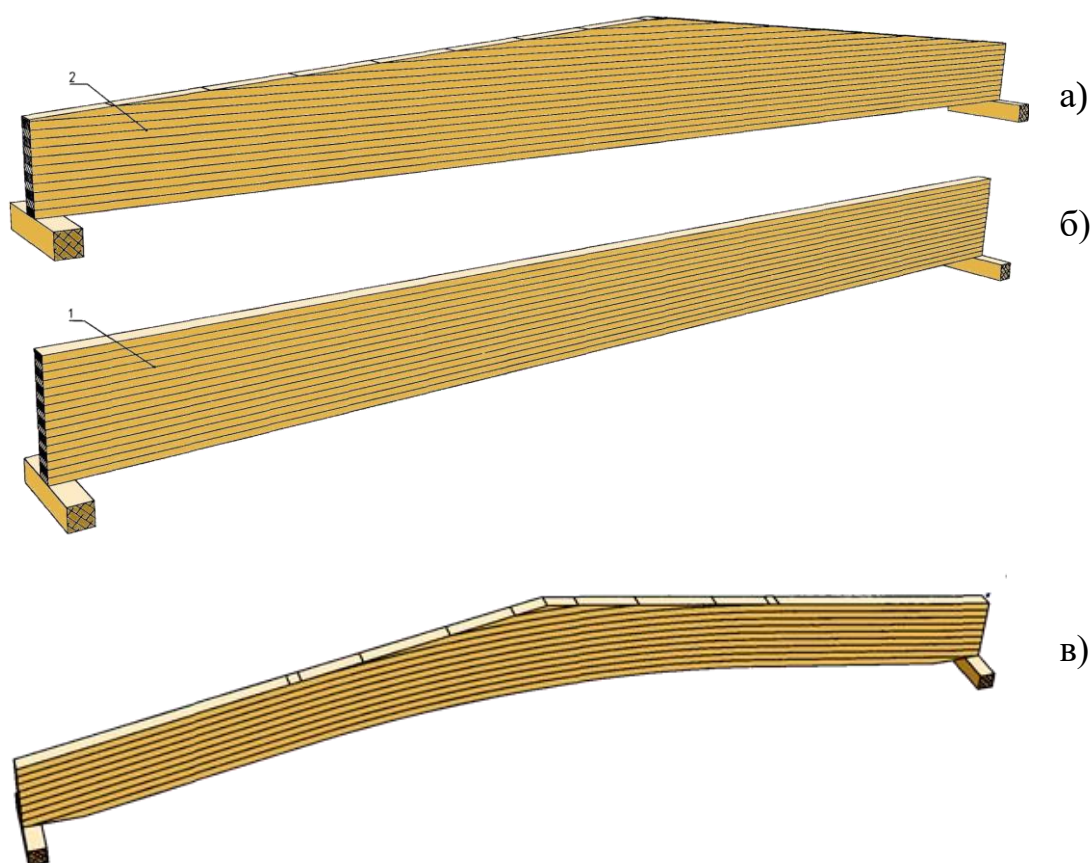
Дощатоклеенные балки из пакета досок: а) - балка постоянной высоты; б) - двускатная балка; в) - гнутоклеенная балка
